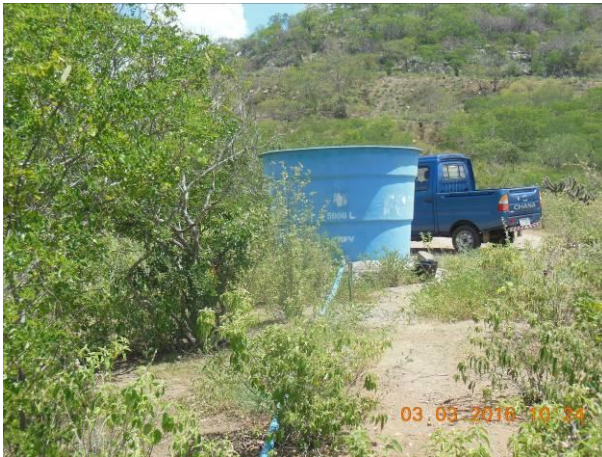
Implantação de caixas de água para irrigação das mudas plantadas.
